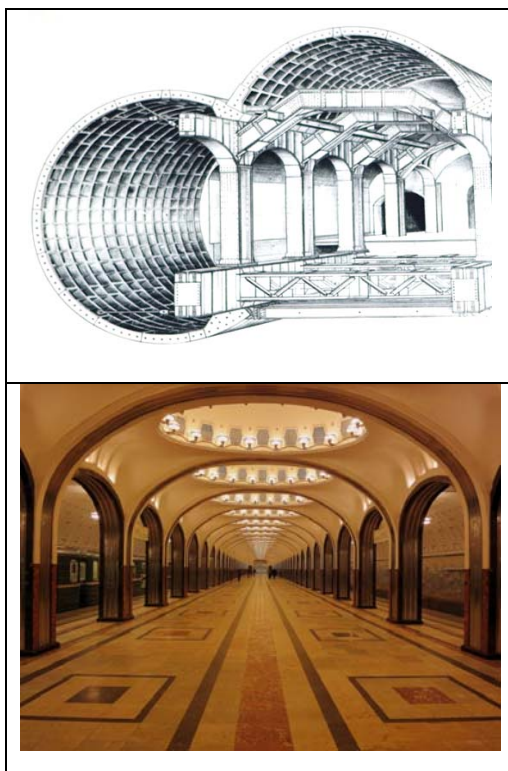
Схема расположения несущих конструкций станции и общий вид центрального тоннеля
